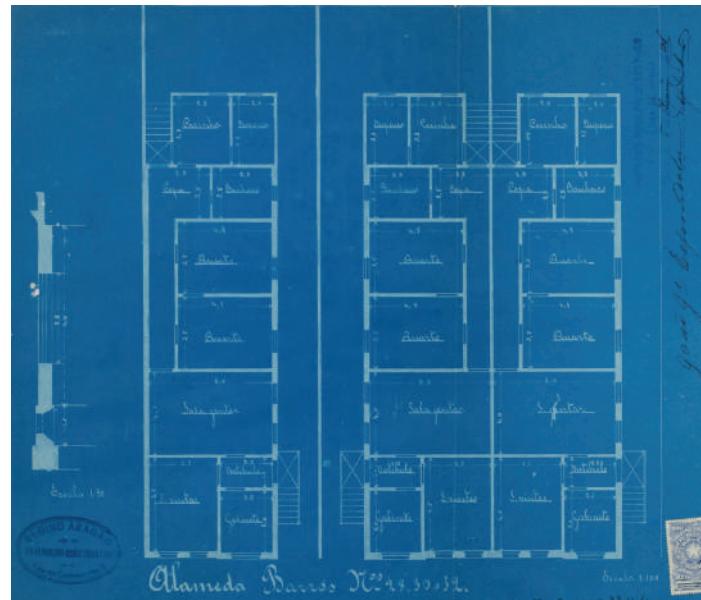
Planta de três casas médias. Construído por Regino Aragão na Alameda Barros n.º 9.330-32. O.P. 1908-000.274
